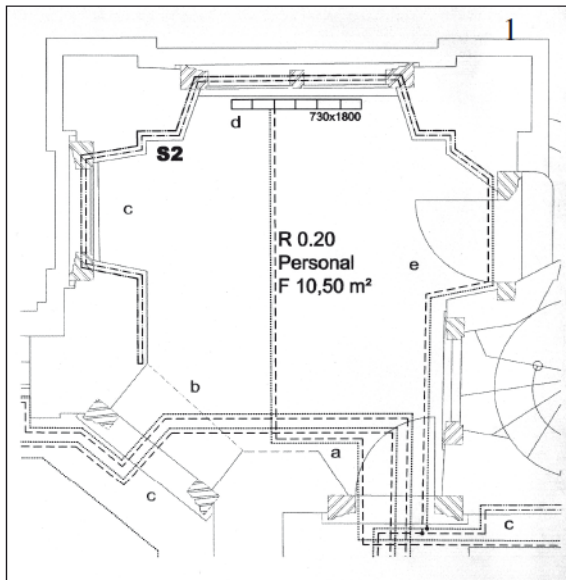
und 36. Auszüge aus den Ausführungsplänen v. l.: 1. Raumgrundriss, 2. Wandabwicklung mit Leitungstrassen.
